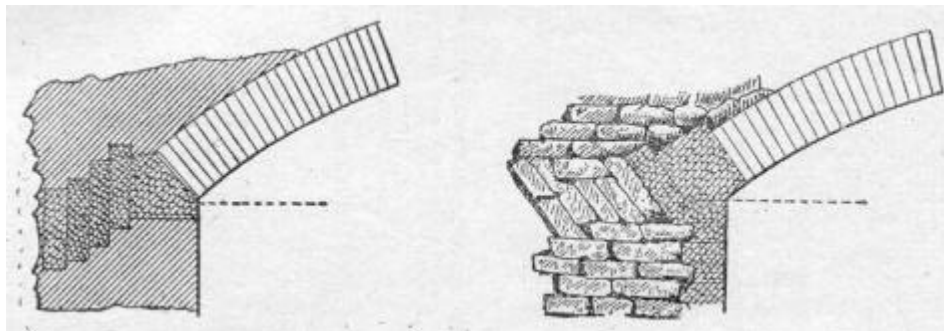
Disposizione dei blocchi in prossimità dell'imposta (Baggi, 1926)
